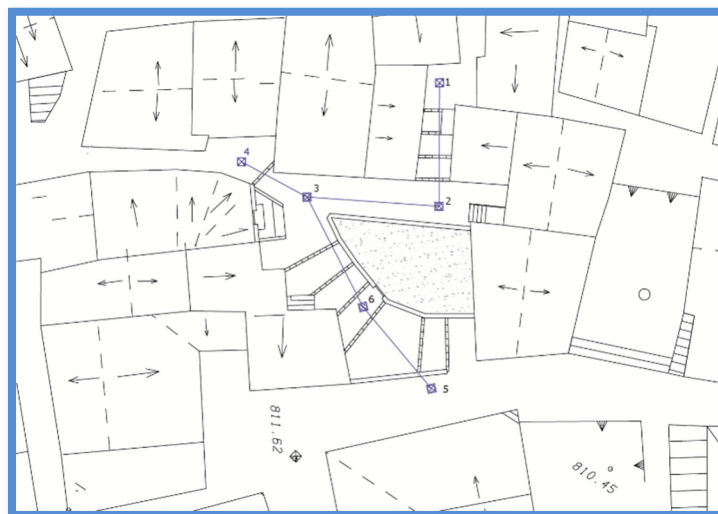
Rappresentazione planimetrica di progetto del Tratto B
